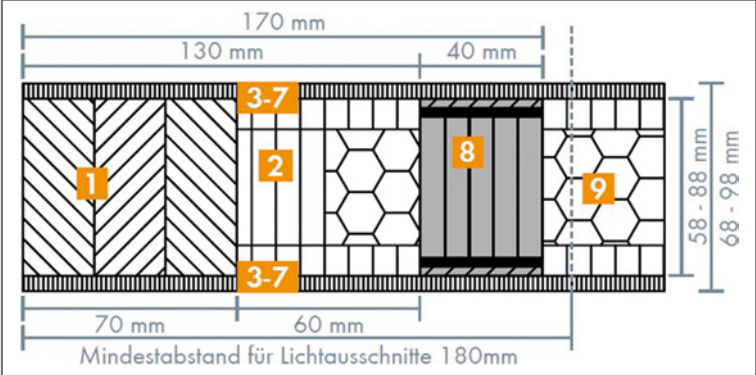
Ausführungsvariante mit Vorsatzschale
